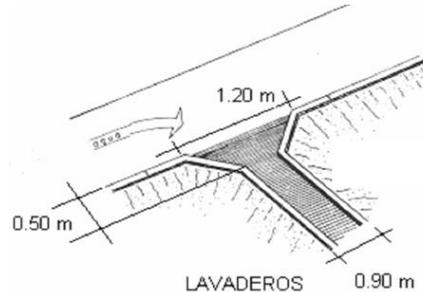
Sección longitudinal y transversal de lavadero de concreto hidráulico
